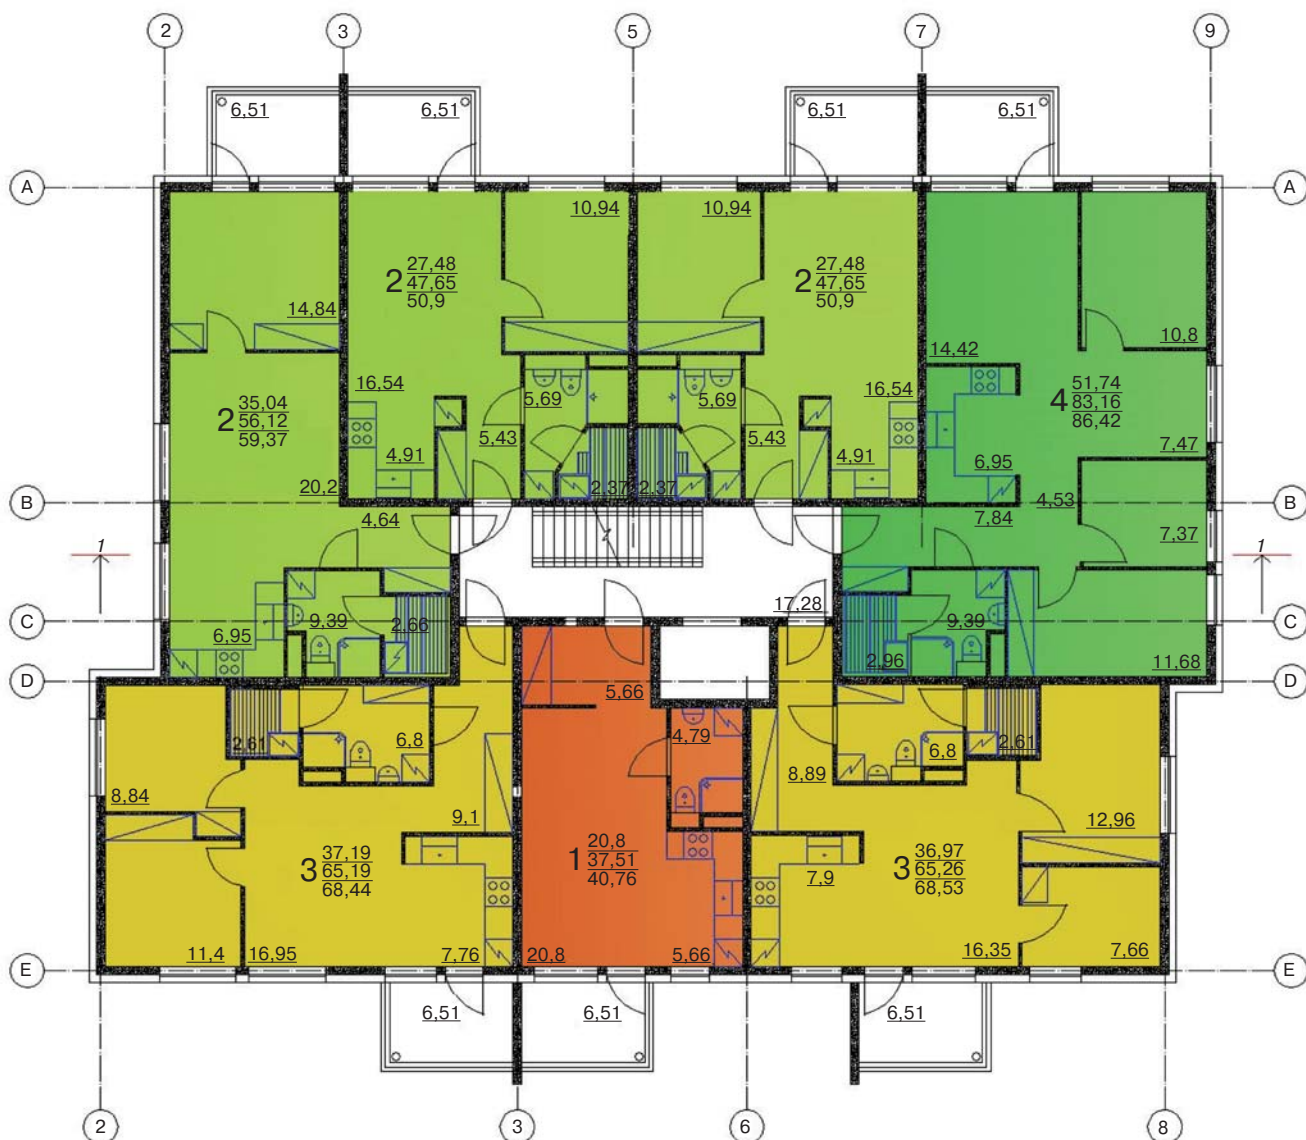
План типового этажа антикризисного крупнопанельного дома с широким шагом несущих стен
